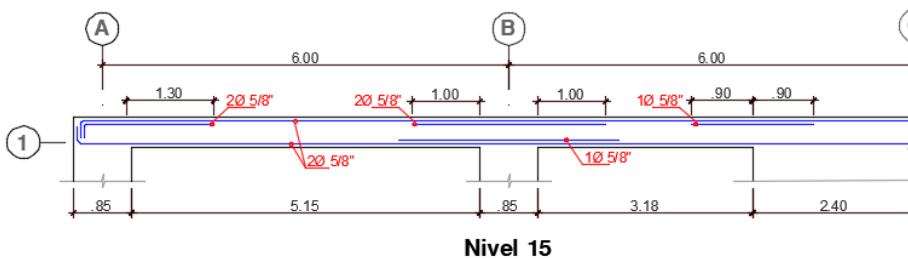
Refuerzo requerido por flexo-tracción en las vigas para el edificio Edi-15
